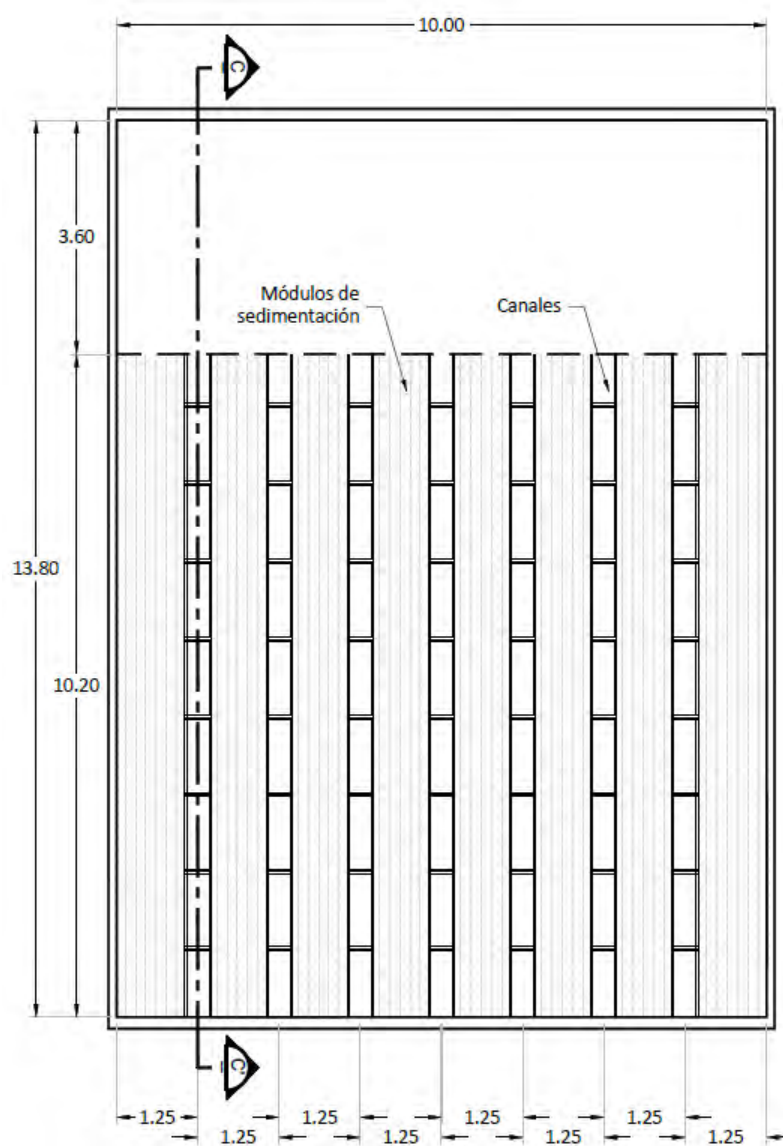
Planta. Tanque de Sedimentación por Floculación.
